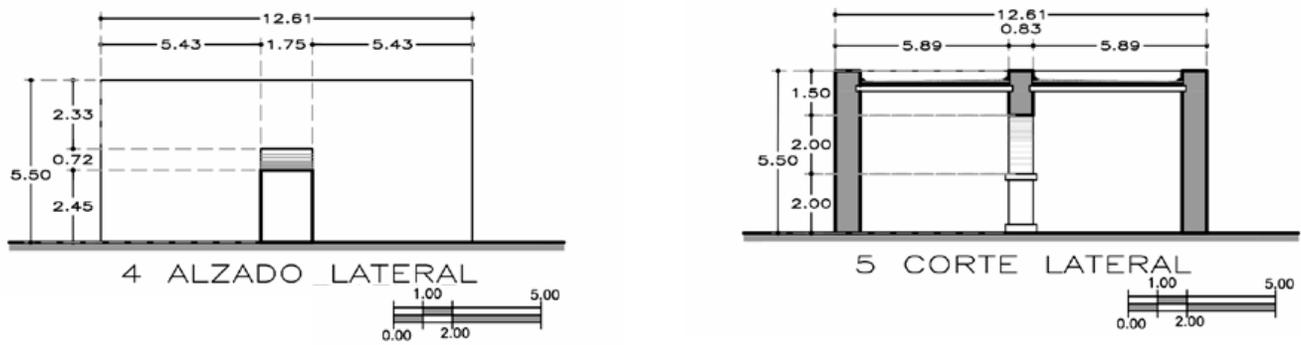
Alzado y corte de fábrica Santa Rosa, por X. Guevara, México, 2014
